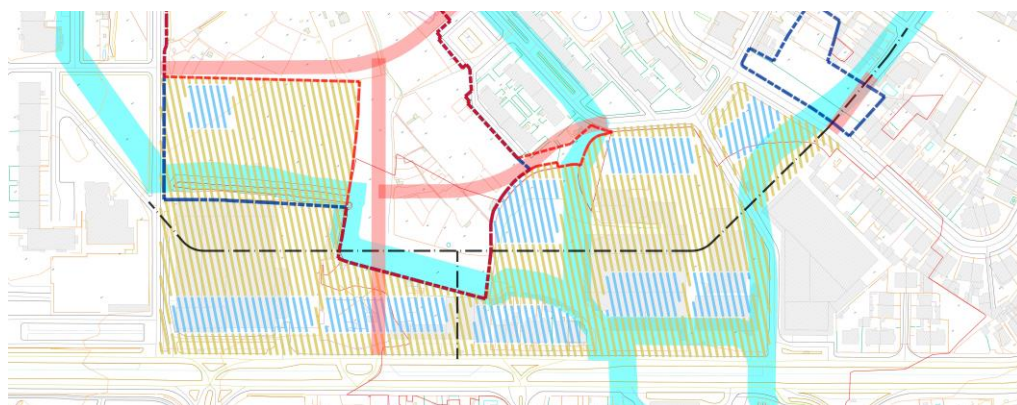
Planta da Solução Urbanística Preliminar (SUP).
